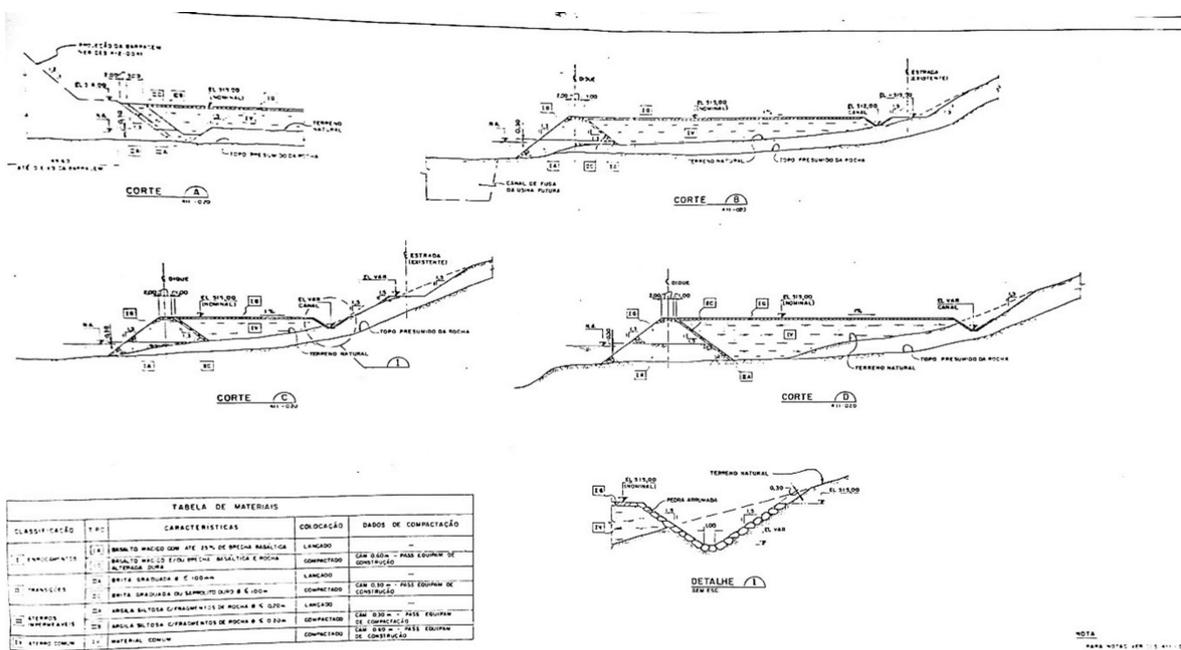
Detalhe indicando a seção da canaleta e cortes indicando os aterros construídos na região do canteiro de obras.
